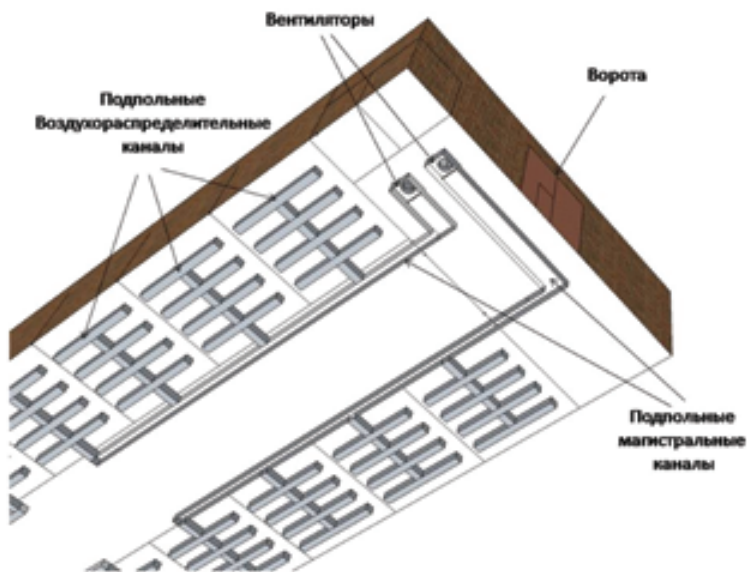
Закромное хранилище с подпольной системой вентиляции (вид снизу)
